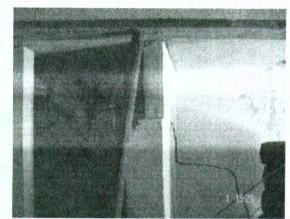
Asentamientos y grietas observadas en los muros de lindero del costado occidental, de la parte posterior de la vivienda del señor Luis Alberto Ramirez (Calle 13 Sur No: 9 – 30 Este).
